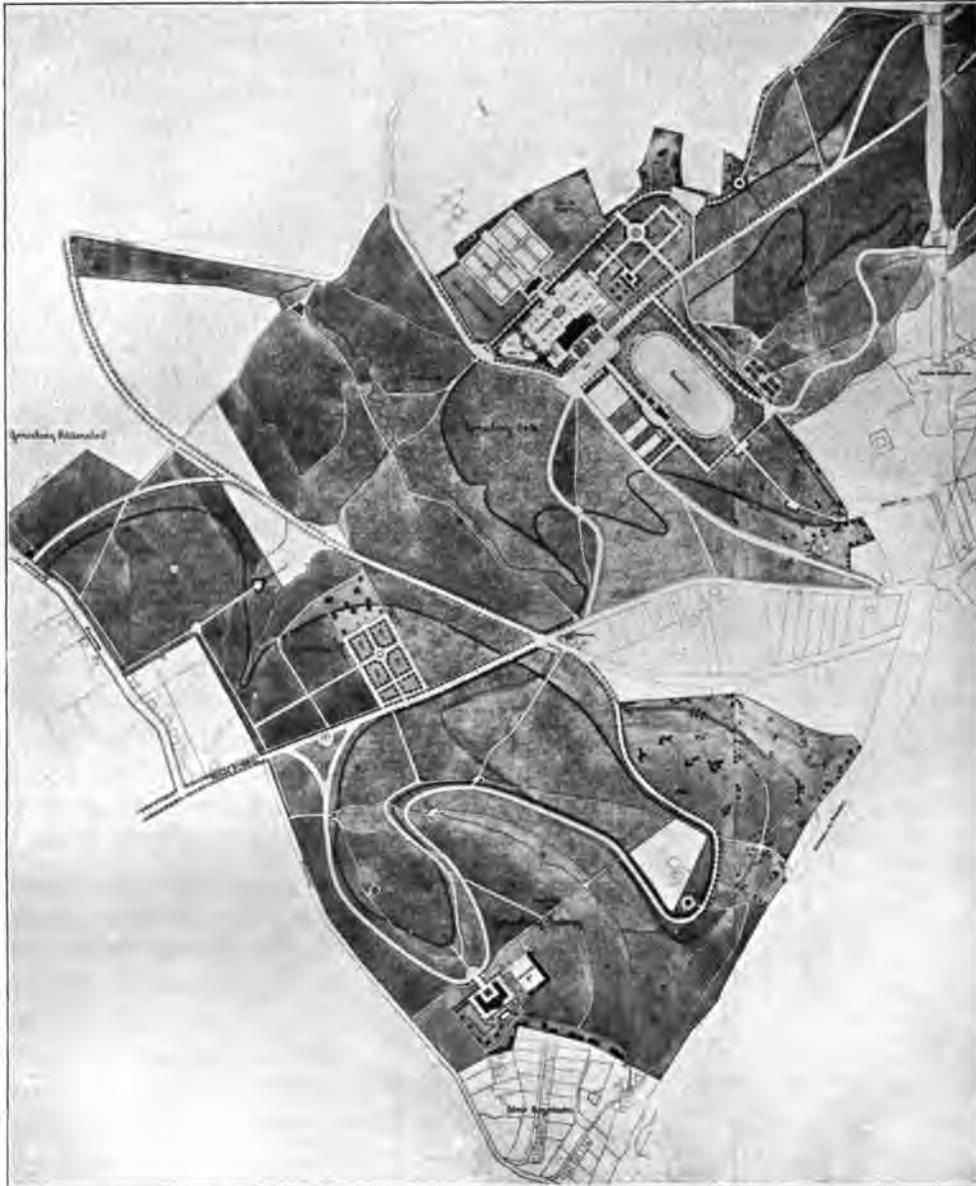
Lageplan für den Stadtwald in Essen. Entwurf von Schulze-Naumburg.
